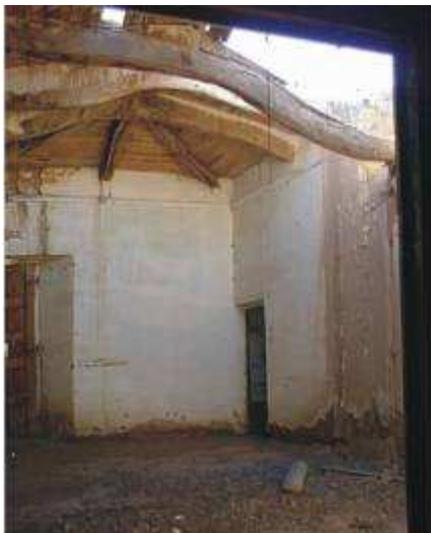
Detalle del estado de deterioro de la casa Tedín en el Pueblo de Cachi.
